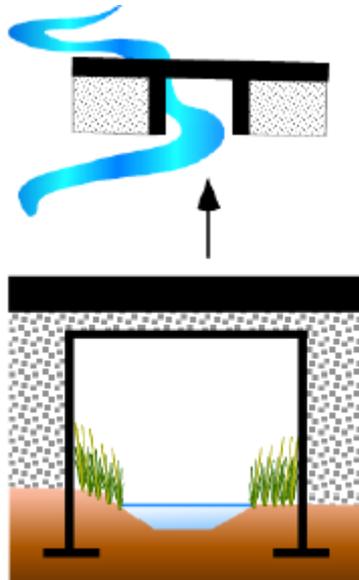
Principe d'implantation d'un ouvrage de franchissement hydraulique ouvert (ONEMA)
